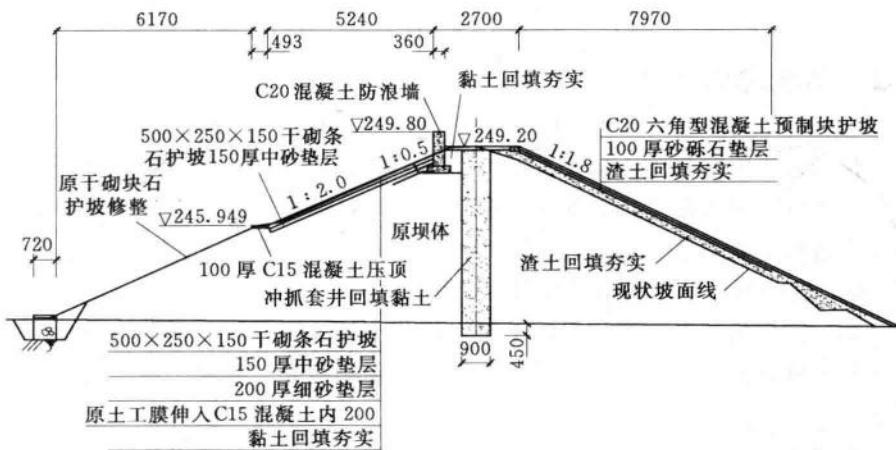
套井回填断面图 (单位: 高程 m; 尺寸 mm)
